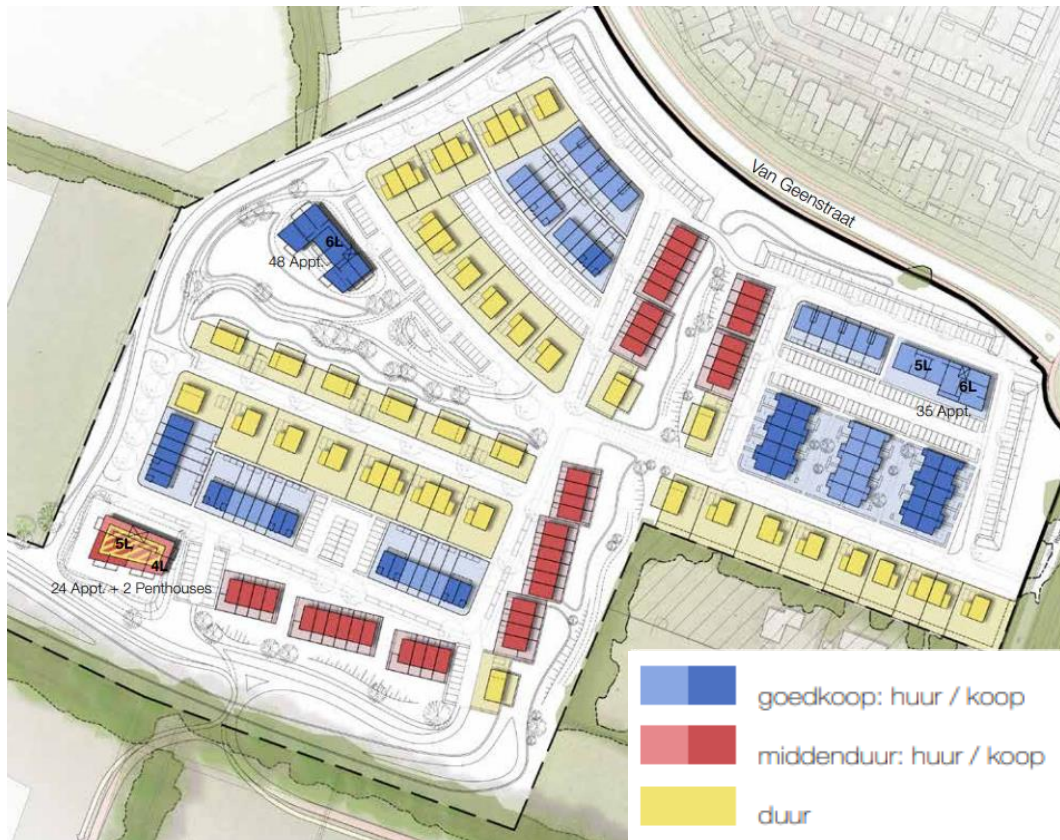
Essentiële kaart van plan voor Halvinkhuizen Fase 1. (bron: BDP en gemeente Putten: concept Beeldkwaliteitsplan & voorbeelduitwerking, augustus 2022)
